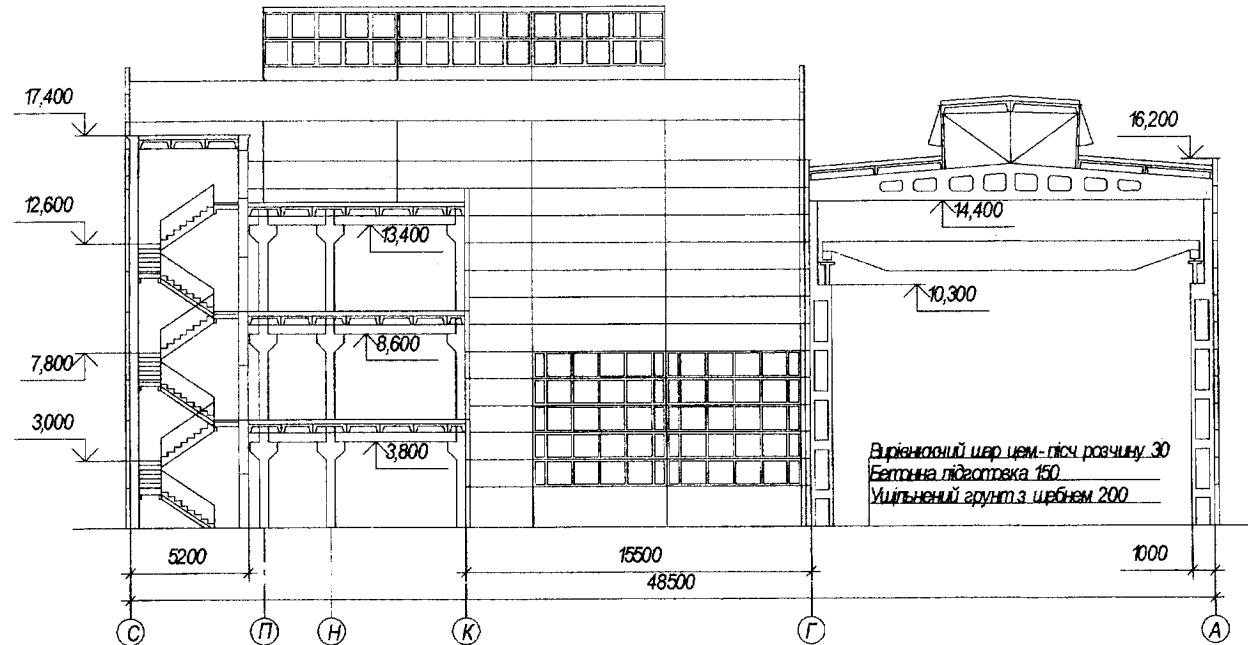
Конструктивний розріз промислової будівлі
